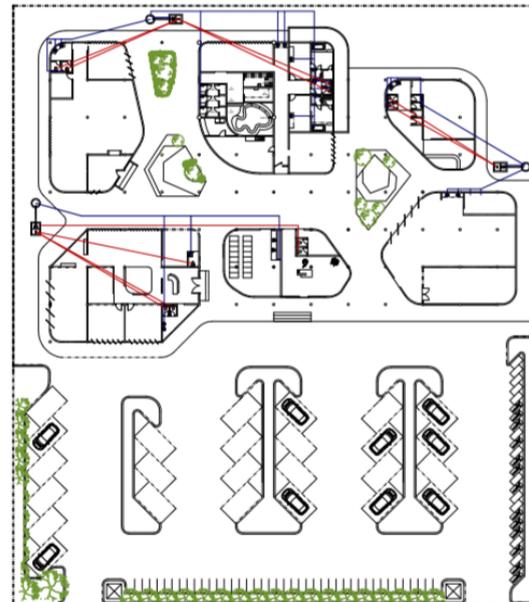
Konsep Tata Ruang Bangunan dan Kavling
